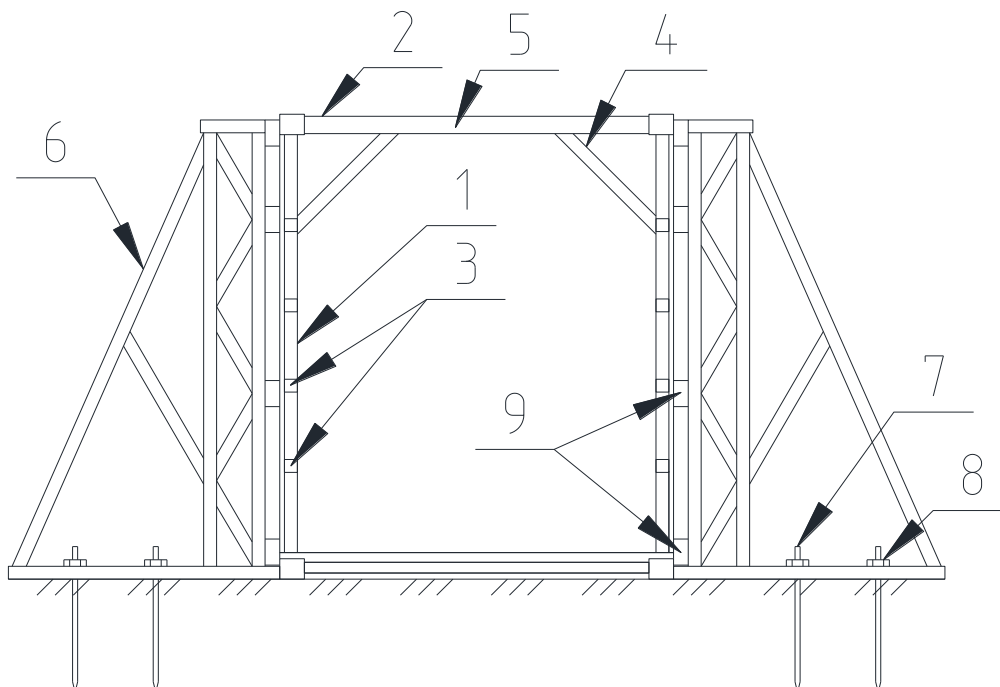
Поперечный разрез базового блок-модуля с элементами усиления:
